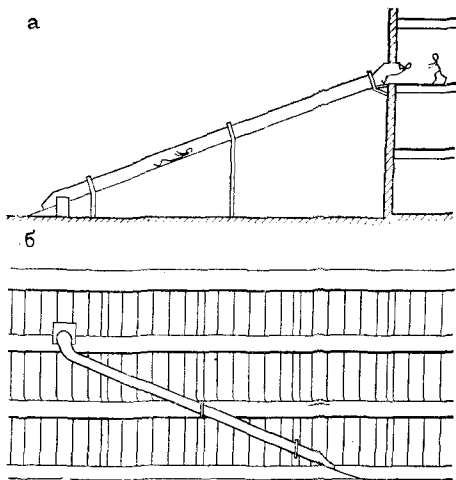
Наклонные спуски поперек (а) и вдоль (б) здания
